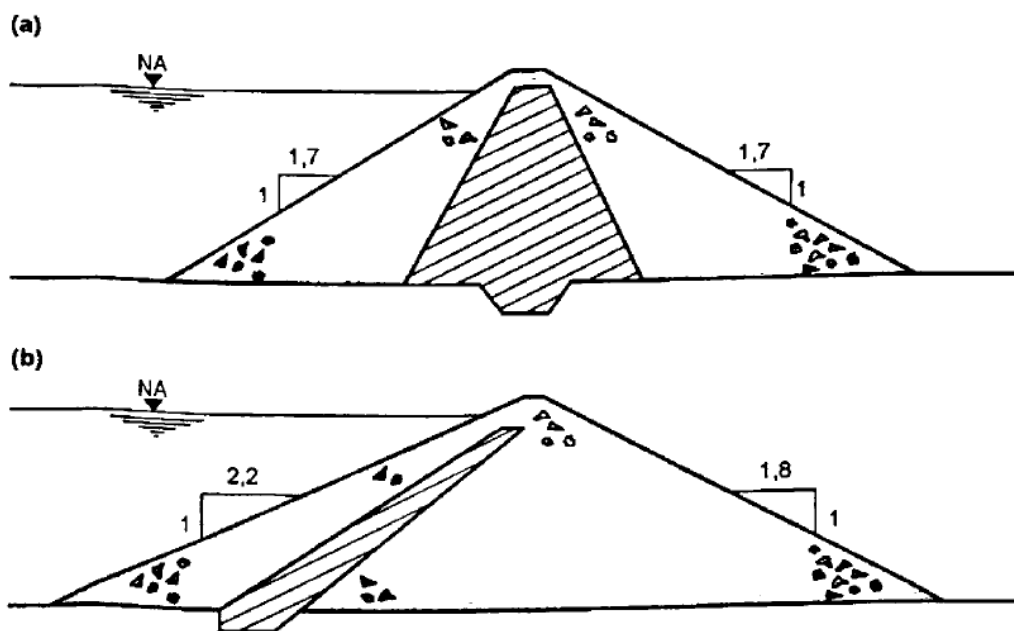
Barragem de seção mista: (a) núcleo de argila centralizado, (b) núcleo de argila inclinado
